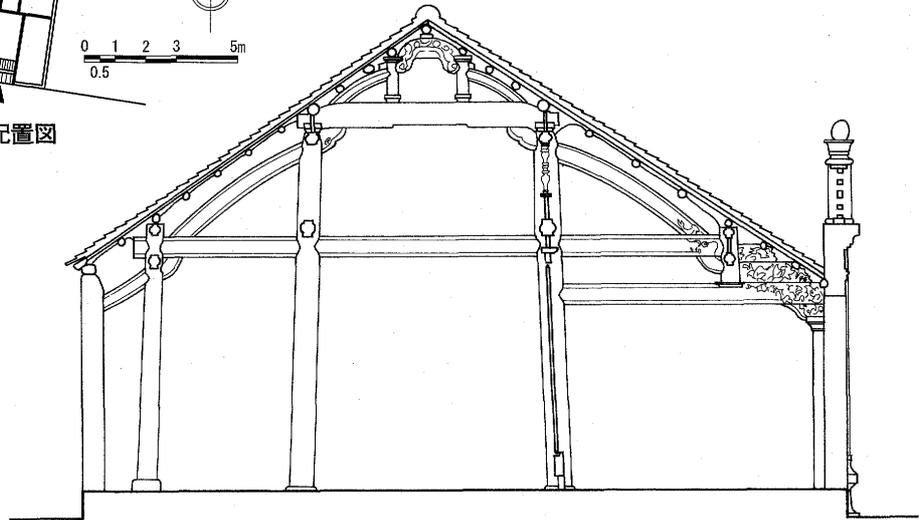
Ha Van Vinh邸 主屋 断面図 1:75
